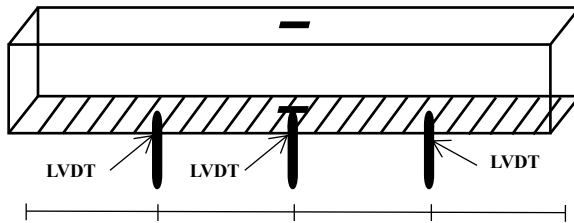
Detail Pemasangan Lapisan GFRP + CFRP
